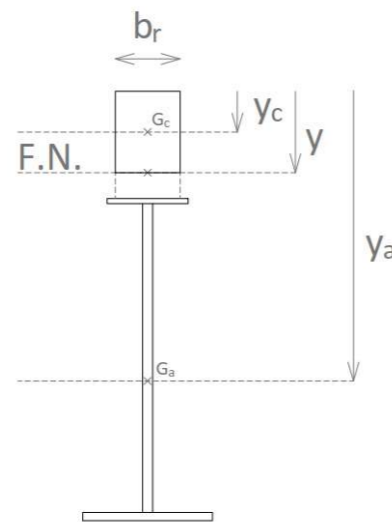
Esquema correspondiente al caso dos: fibra neutra en la losa de hormigón (fuente: elaboración propia)
